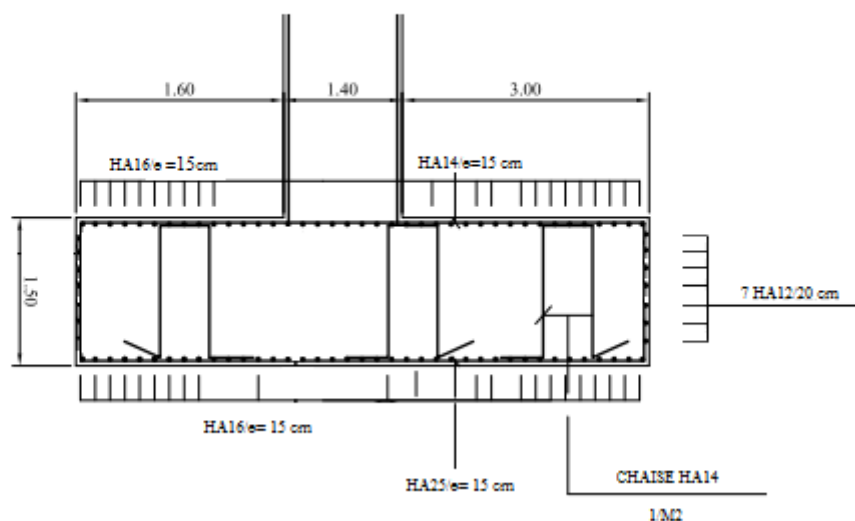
plan de ferrailage de la semelle sous la culée
